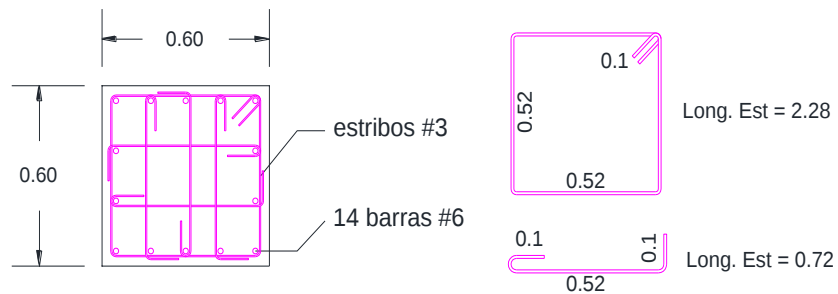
Detalle sección transversal COL 60 x 60 (DMO)
